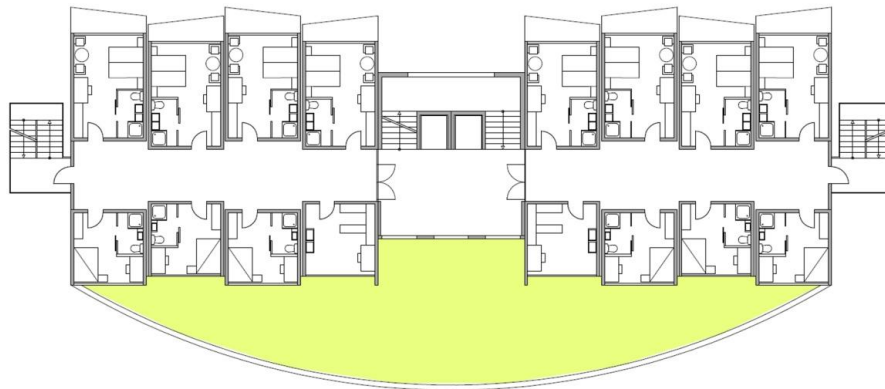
Grundriss OG Eigenentwurf Hotelgebäude
